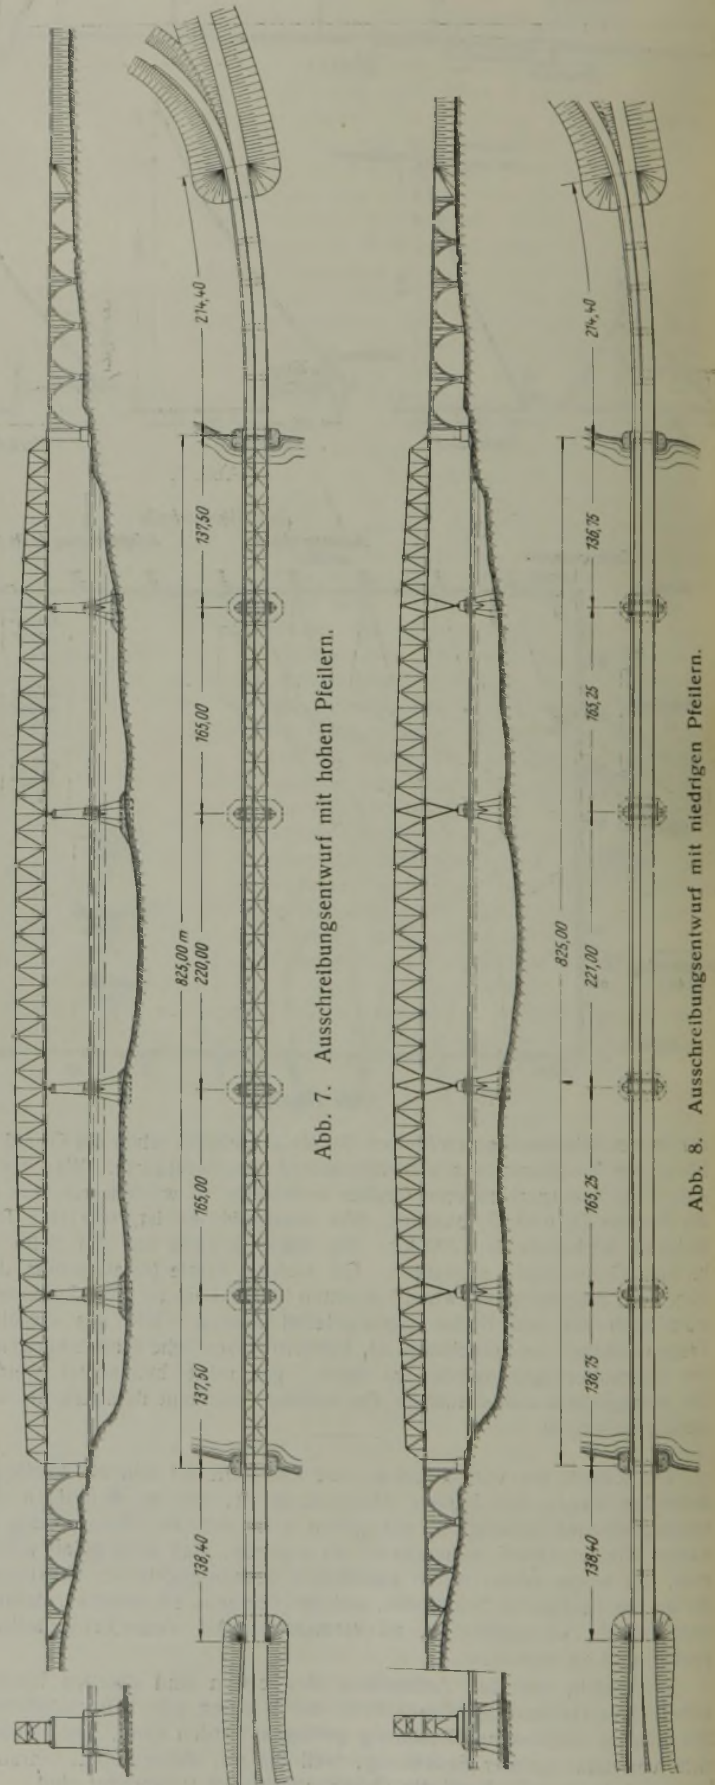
Ausschreibungsentwurf mit hohen Pfeilern.
